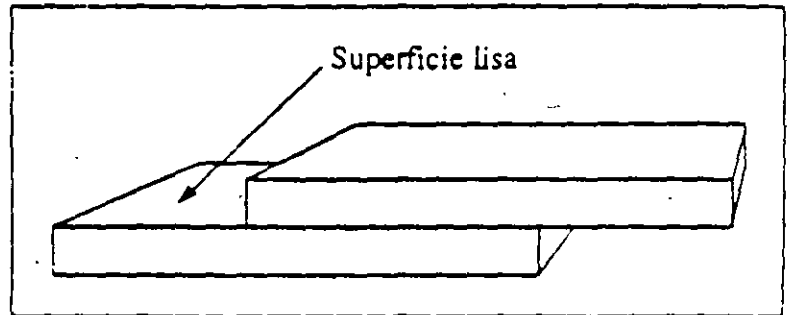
Apoyo, tipo 41, Apoyo de deslizamiento de acero (placas de acero)
